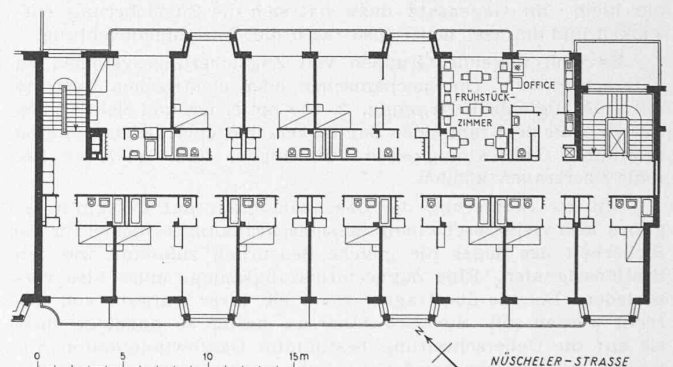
Grundriss vom ersten Stock. — Masstab 1 : 400
